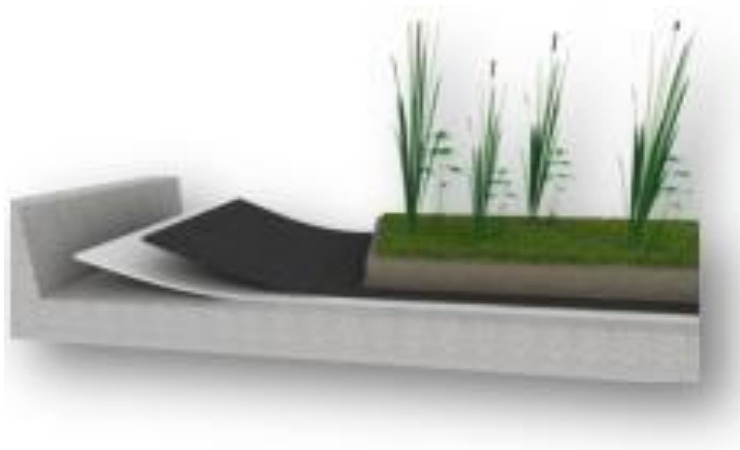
Estructura ajardinada para las terrazas donde se utilizan impermeables para la humedad
